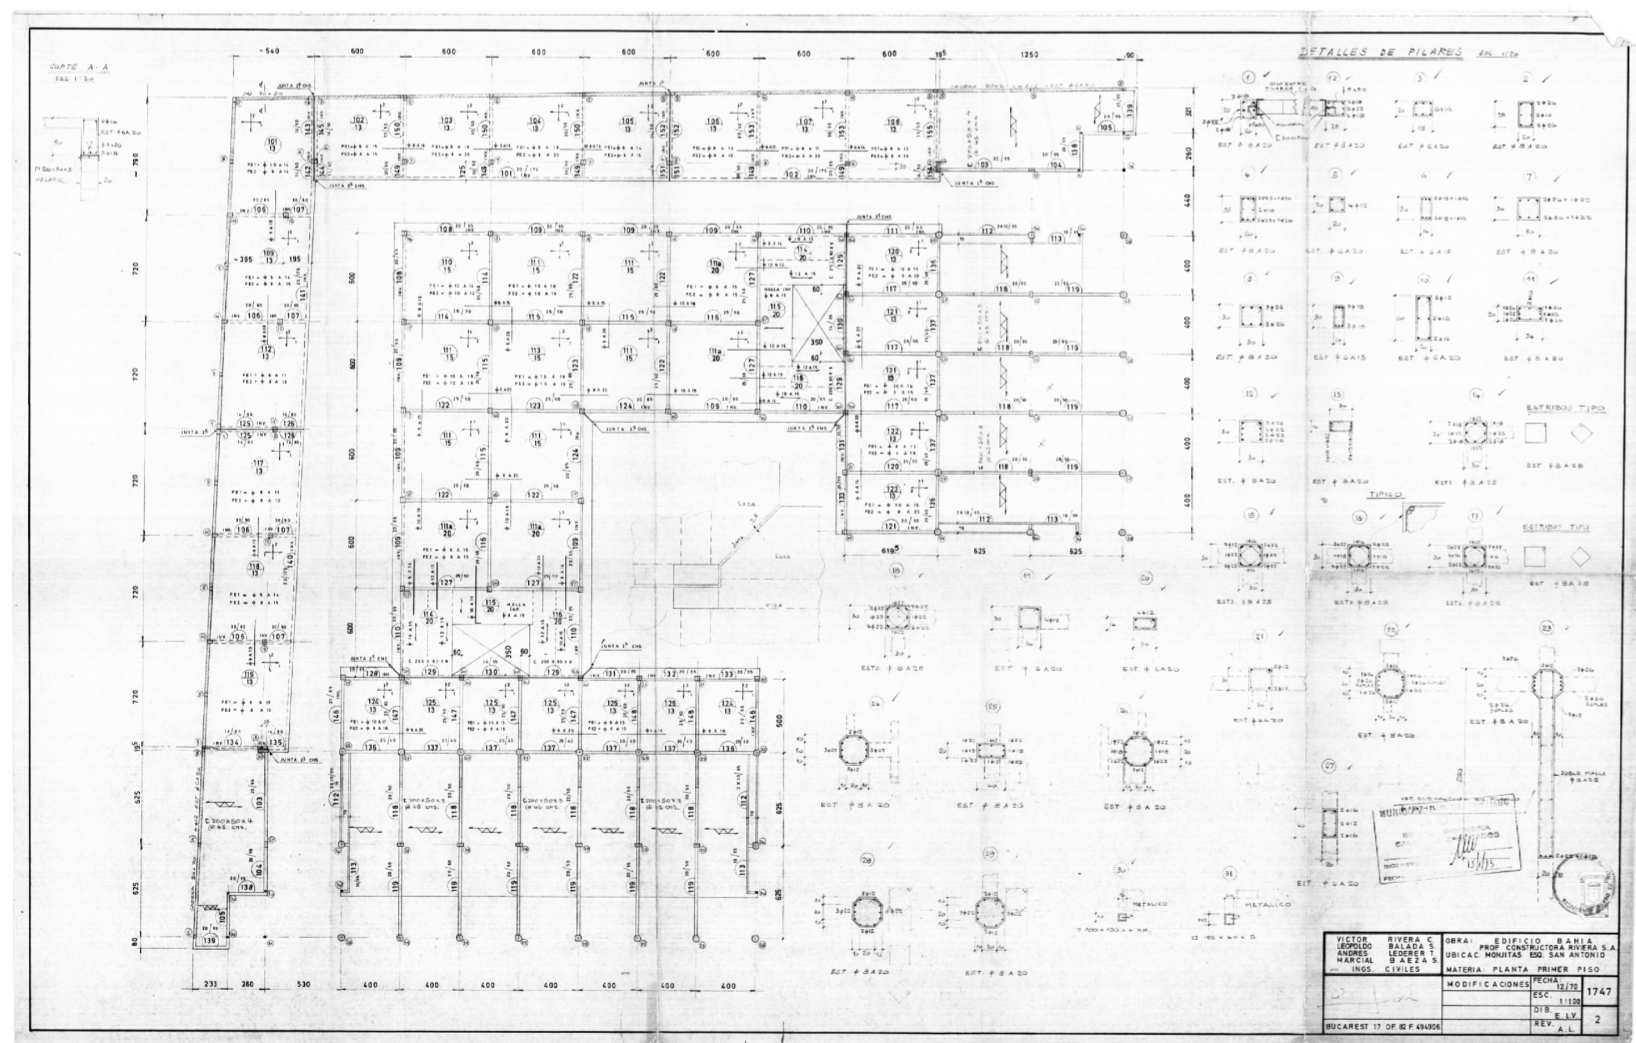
Archivo Plano Municipal. Planta estructural.
